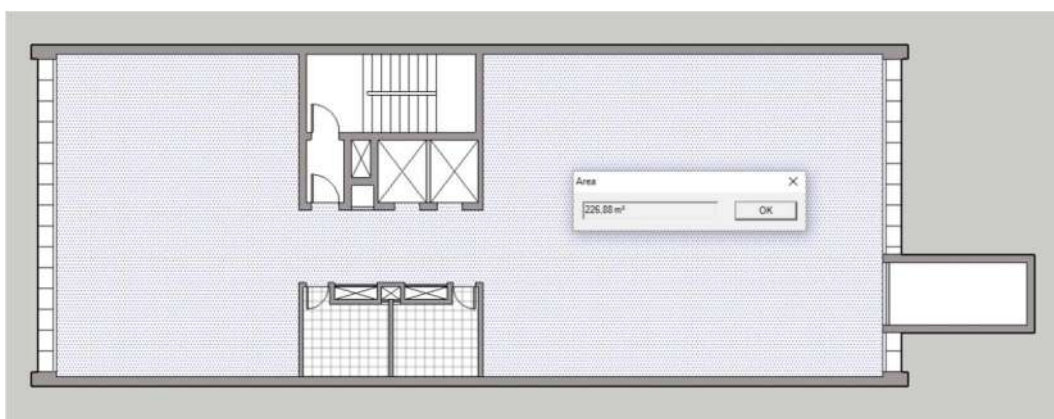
Planta baixa simplificada de andar padrão do edifício.
